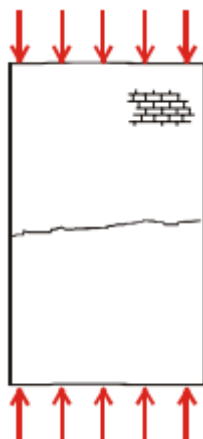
fissuras horizontais causadas por sobrecarga (DUARTE, 1998).
